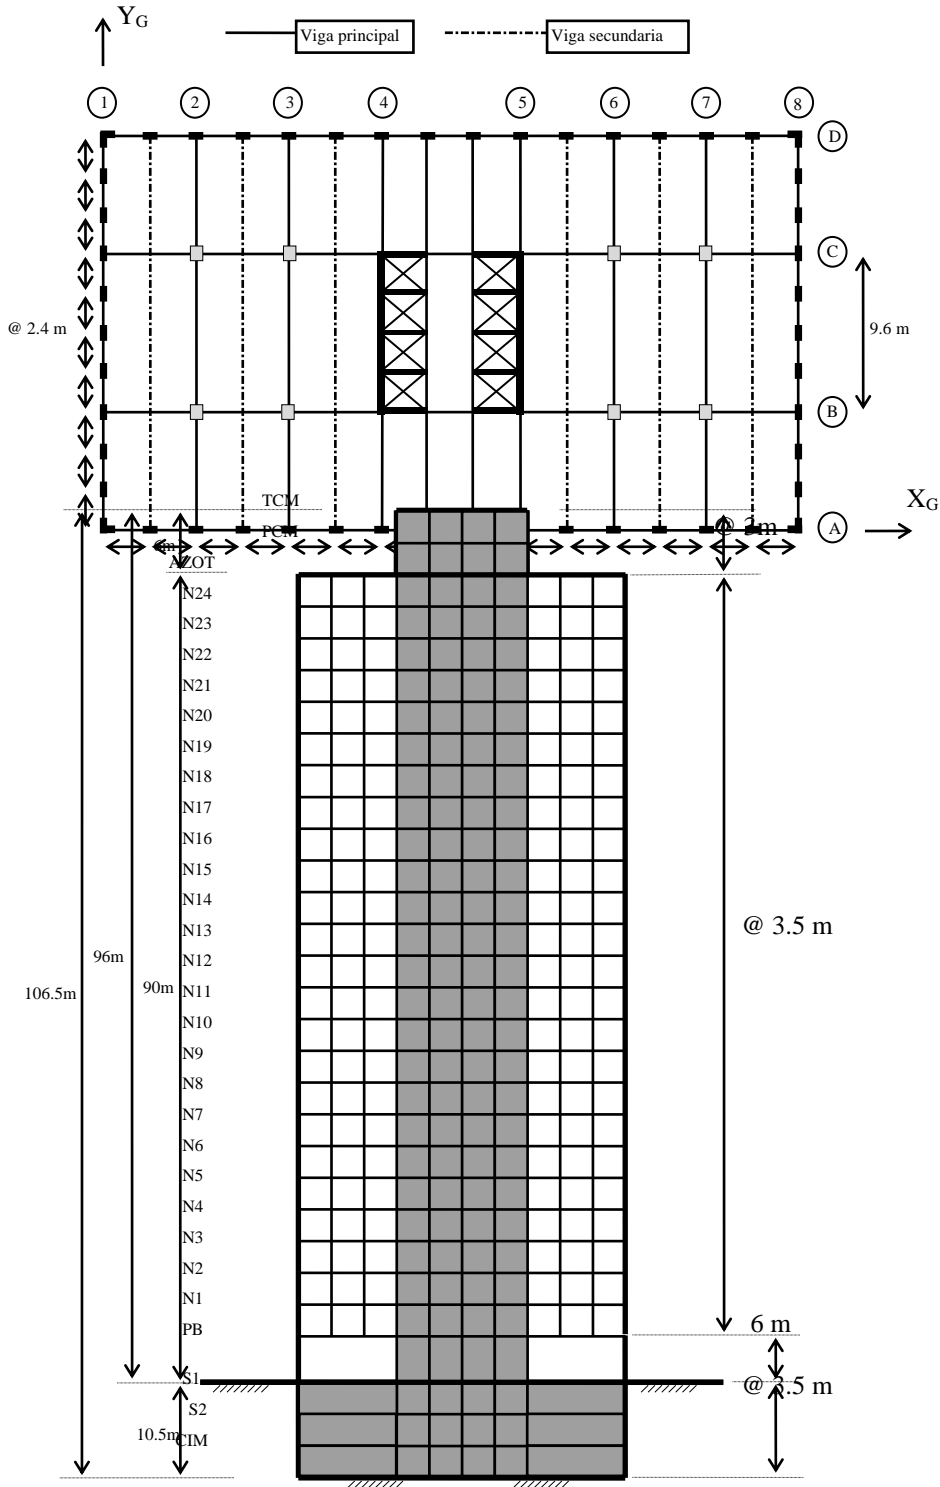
Planta tipo niveles N1 a Azot, y corte esquemático en elevación, dirección Y
